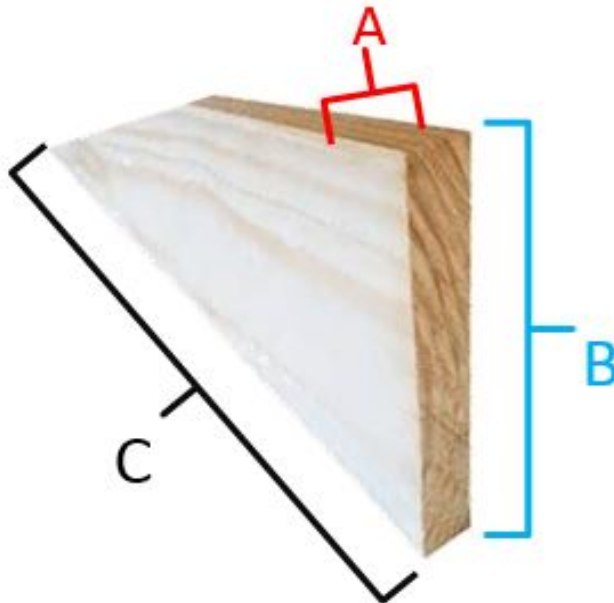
(Elaboración propia, 2019). Ilustración de madera.
